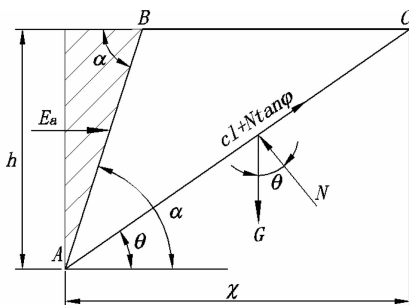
岩石边坡的坡面为倾斜时计算简图
